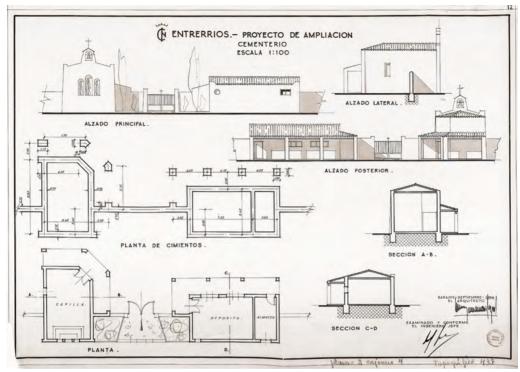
Plantas y alzados del Cementerio de Entrerríos.
